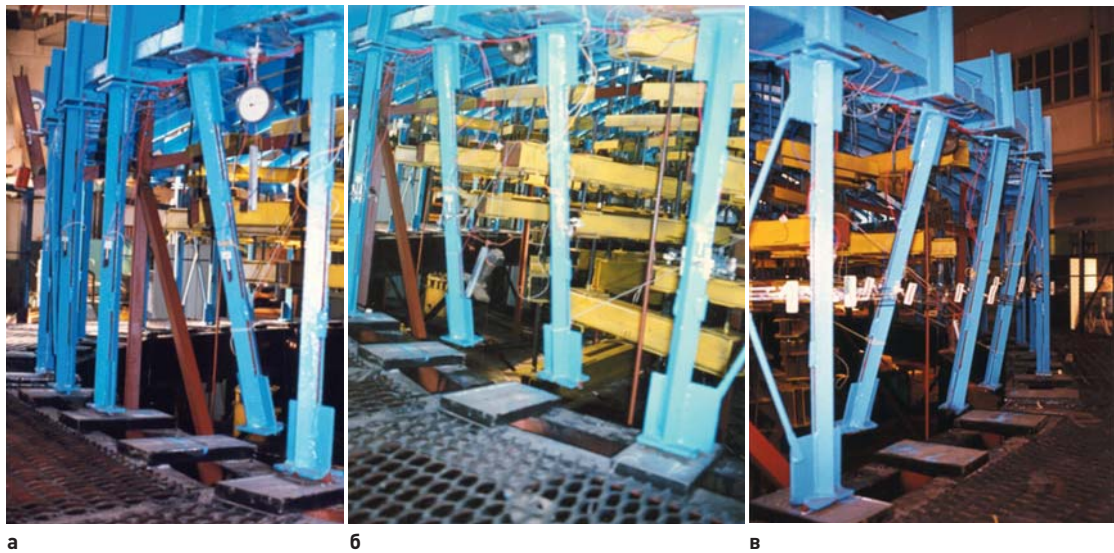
Испытания, моделирующие устойчивость каркаса от прогрессирующего обрушения, исключением из работы: *а* – одной колонны; *б* – двух колонн; *в* – трех колонн
